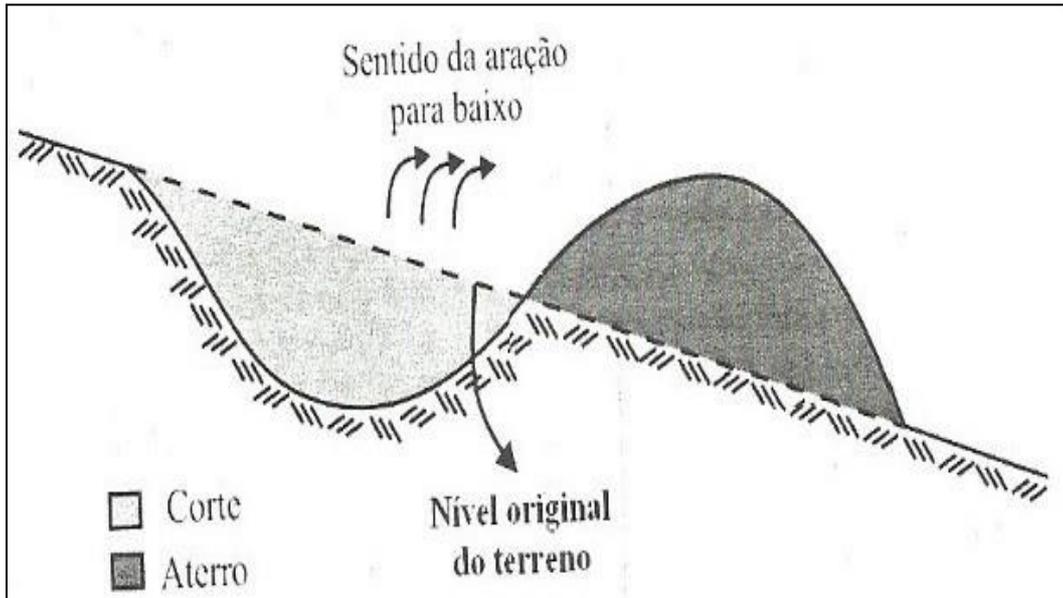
Perfil esquemático de um terraço tipo Nichol's
